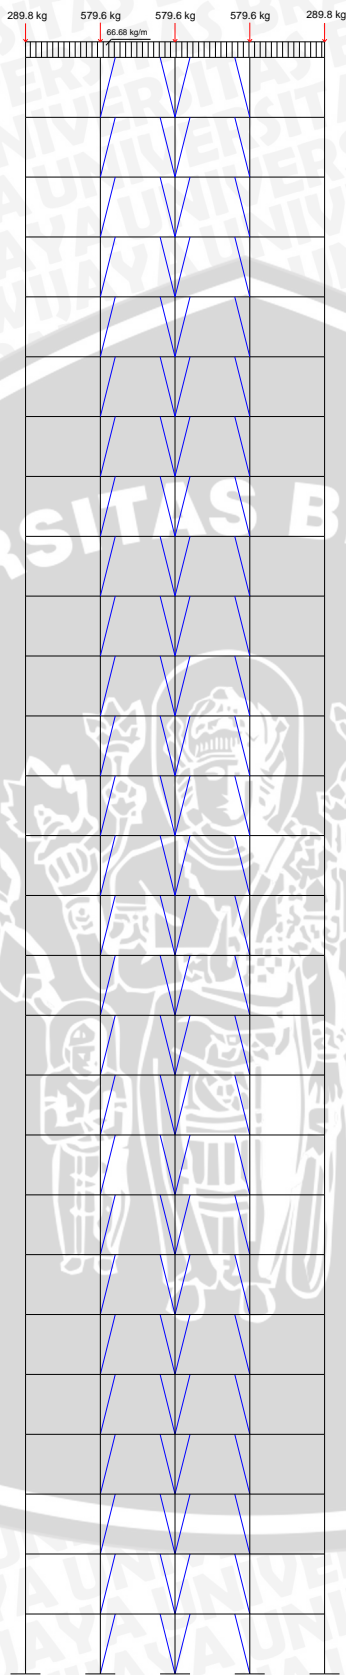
Beban Hujan Portal 27 Lantai Tipe B
